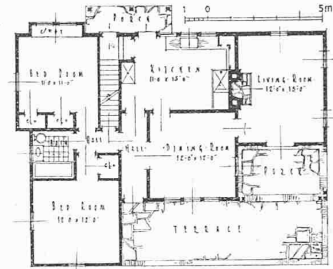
Grundriss 1:300 zu Abb. 4.
